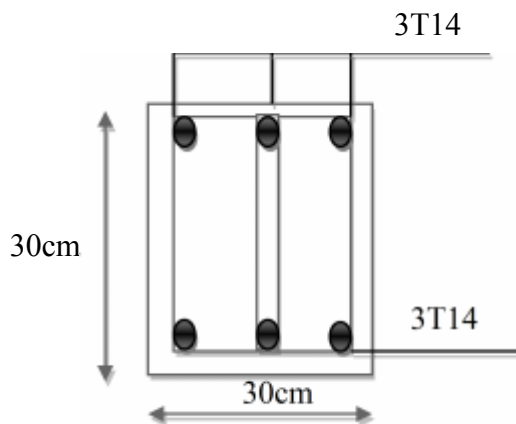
Ferrailage de la poutre secondaire en travée
